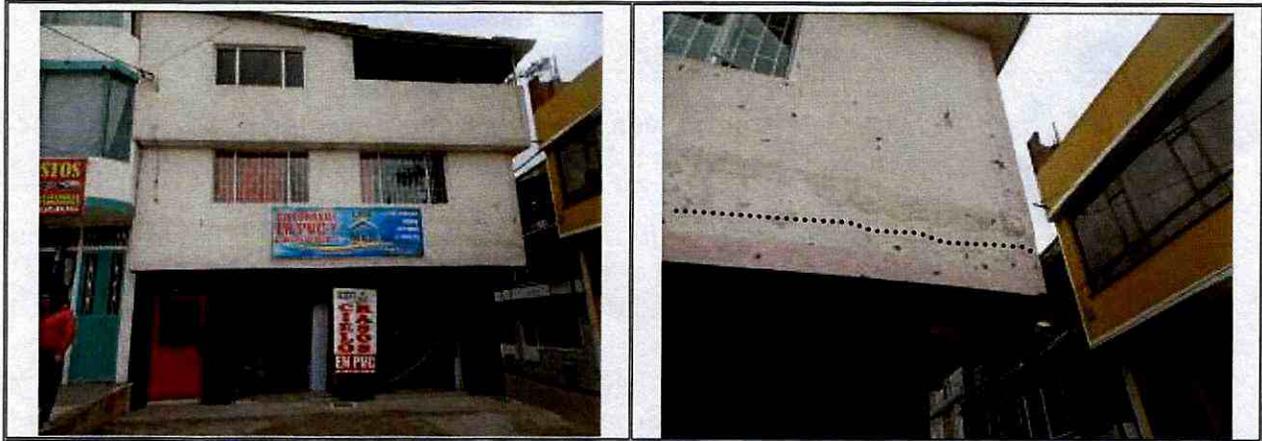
y 2. Vista frontal de la vivienda emplazada en el predio de la Avenida Calle 43 Sur No. 82 B – 15 y fisuras en muro de fachada
